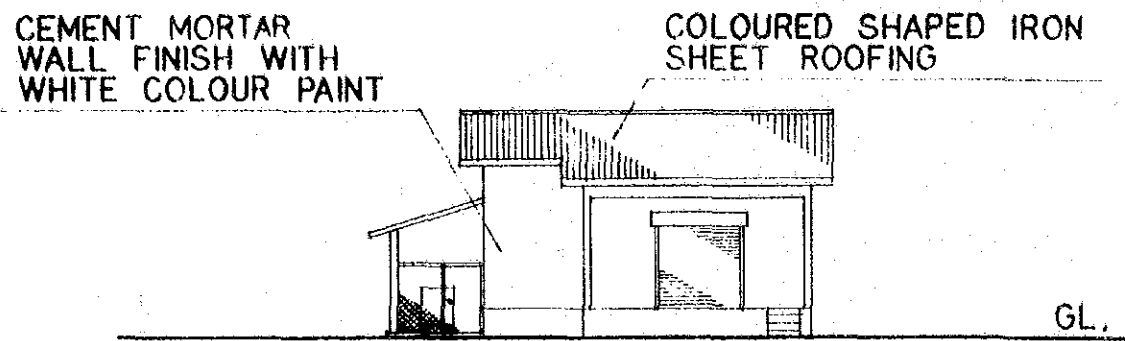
ヴァウワーフィールド空港冷蔵庫配置図
